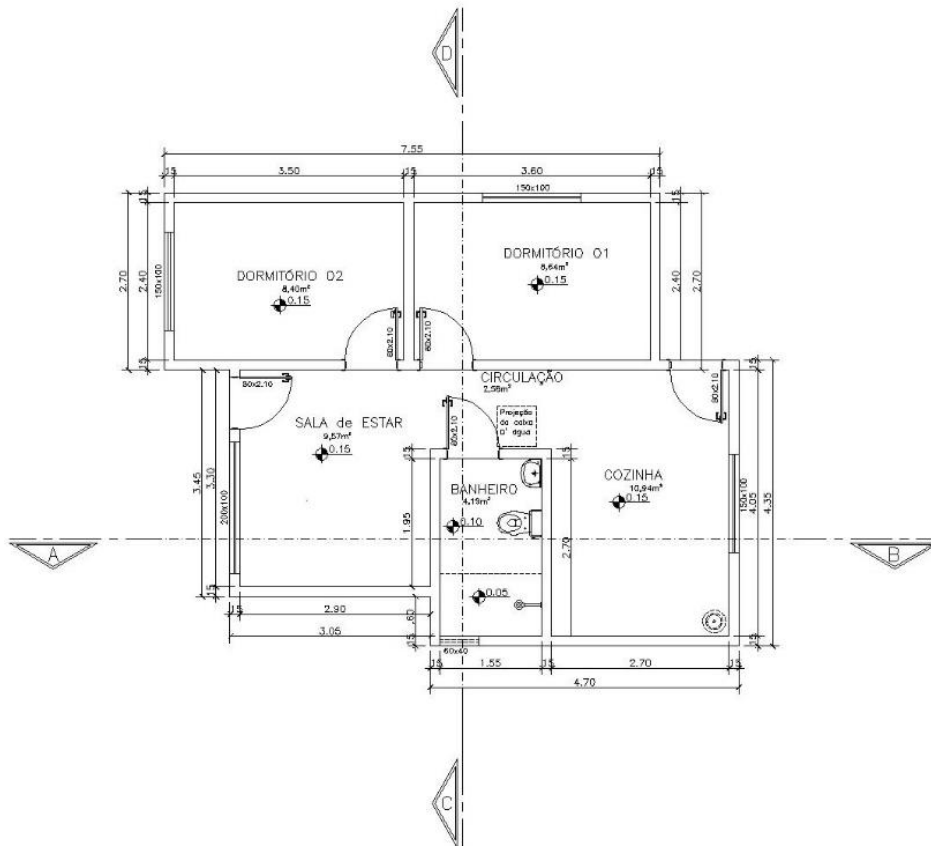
Planta baixa – Fonte: Autor, (2018).
